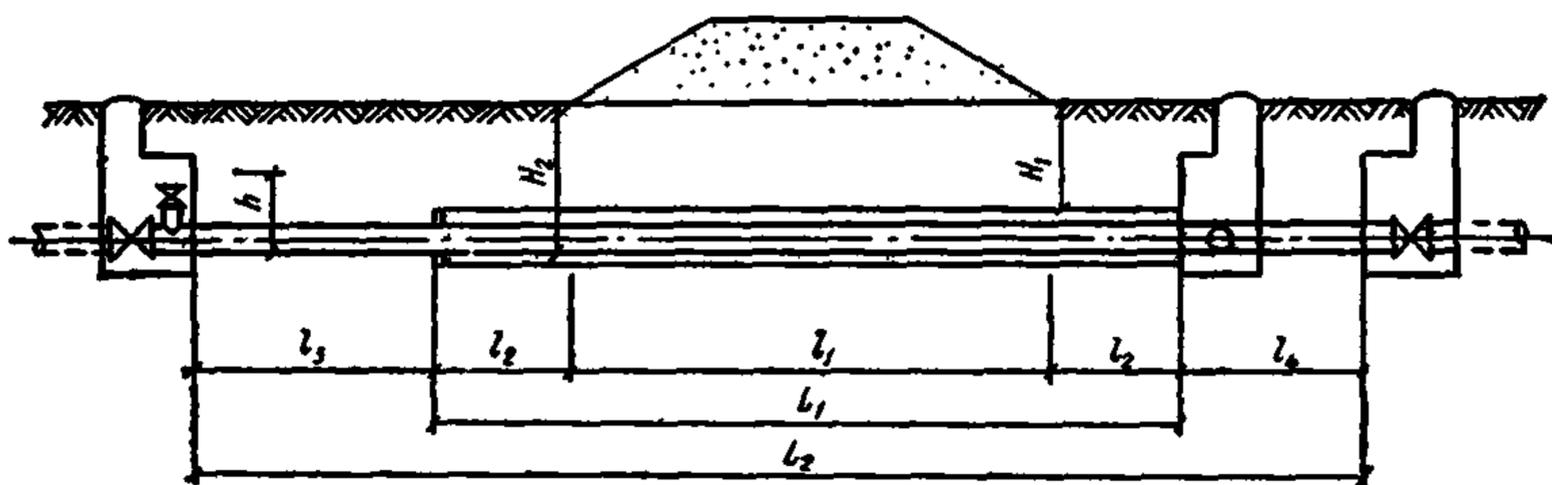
Схема перехода напорным трубопроводом: h — высота стояния грунтовых вод; H_1 — заглубление до верха кожуха; H_2 — глубина заложения рабочего трубопровода; l_1 — длина проходки; l_2 — наращивание кожуха; l_3 — ремонтный участок; l_4 — участок до колодца с отключающей арматурой; L_1 — длина стального кожуха; L_2 — длина рабочего трубопровода
